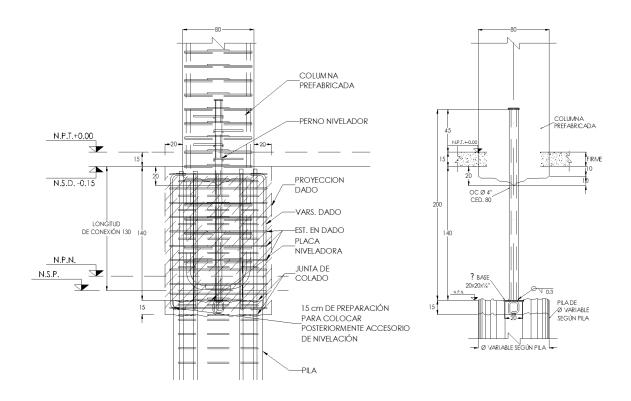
Detalle de conexión de la pila de cimentación con columna prefabricada.
